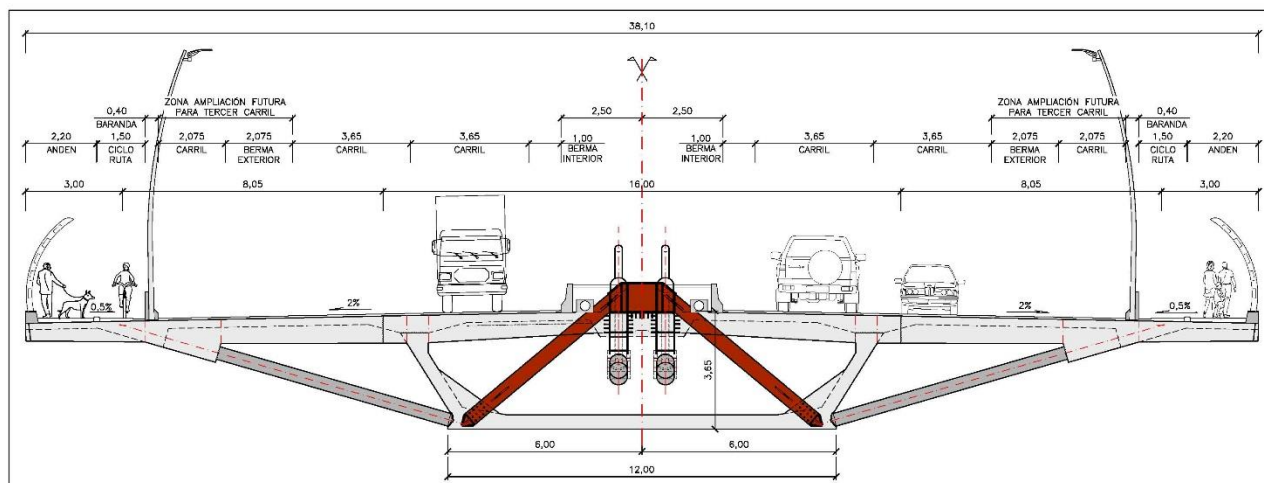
Sección transversal por costilla tipo con anclaje de tirantes
